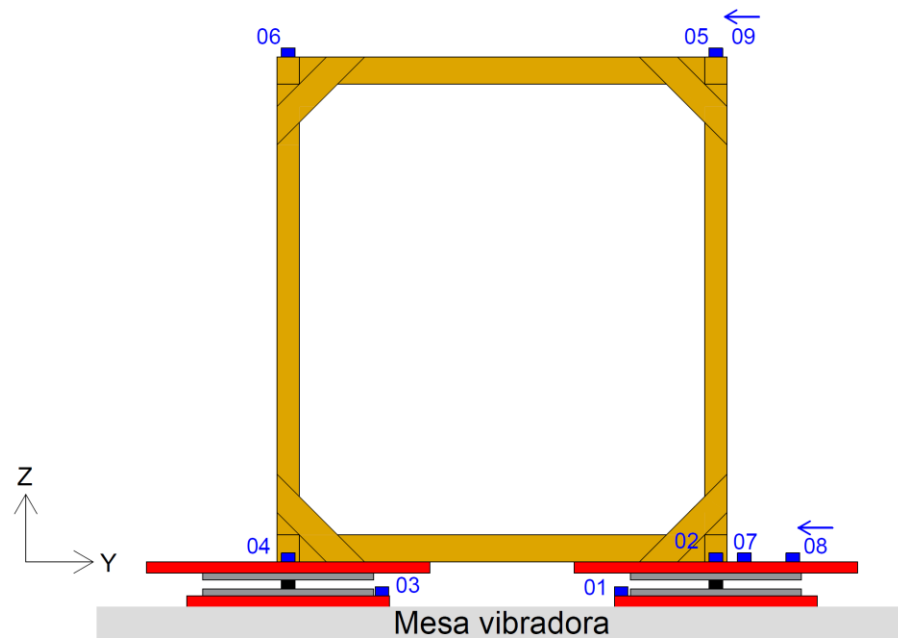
Croquis de vista en planta de estructura aislada instrumentada en mesa vibradora, plano YZ.
